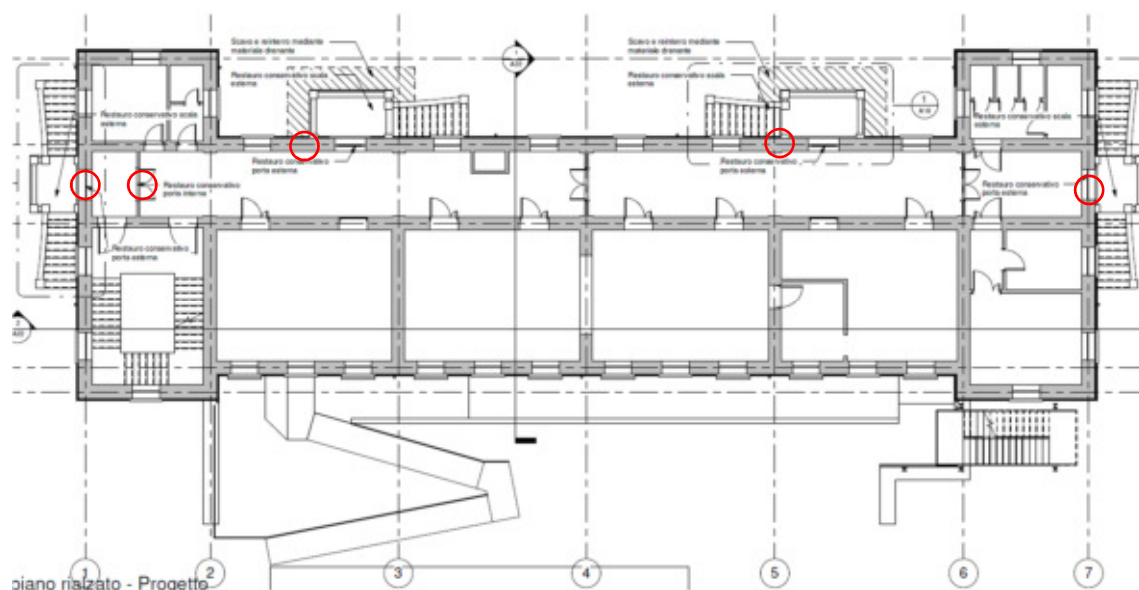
Pianta piano rialzato – Indicazione porte da restaurare
